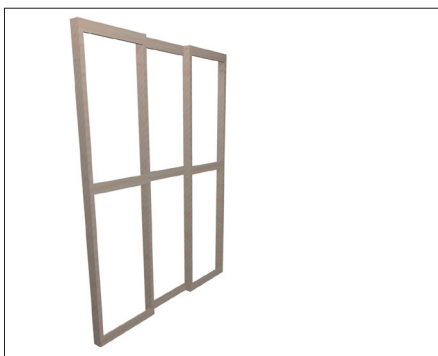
Konstruktion: Holzständer oder Leichtbauwand als Grundgerüst
